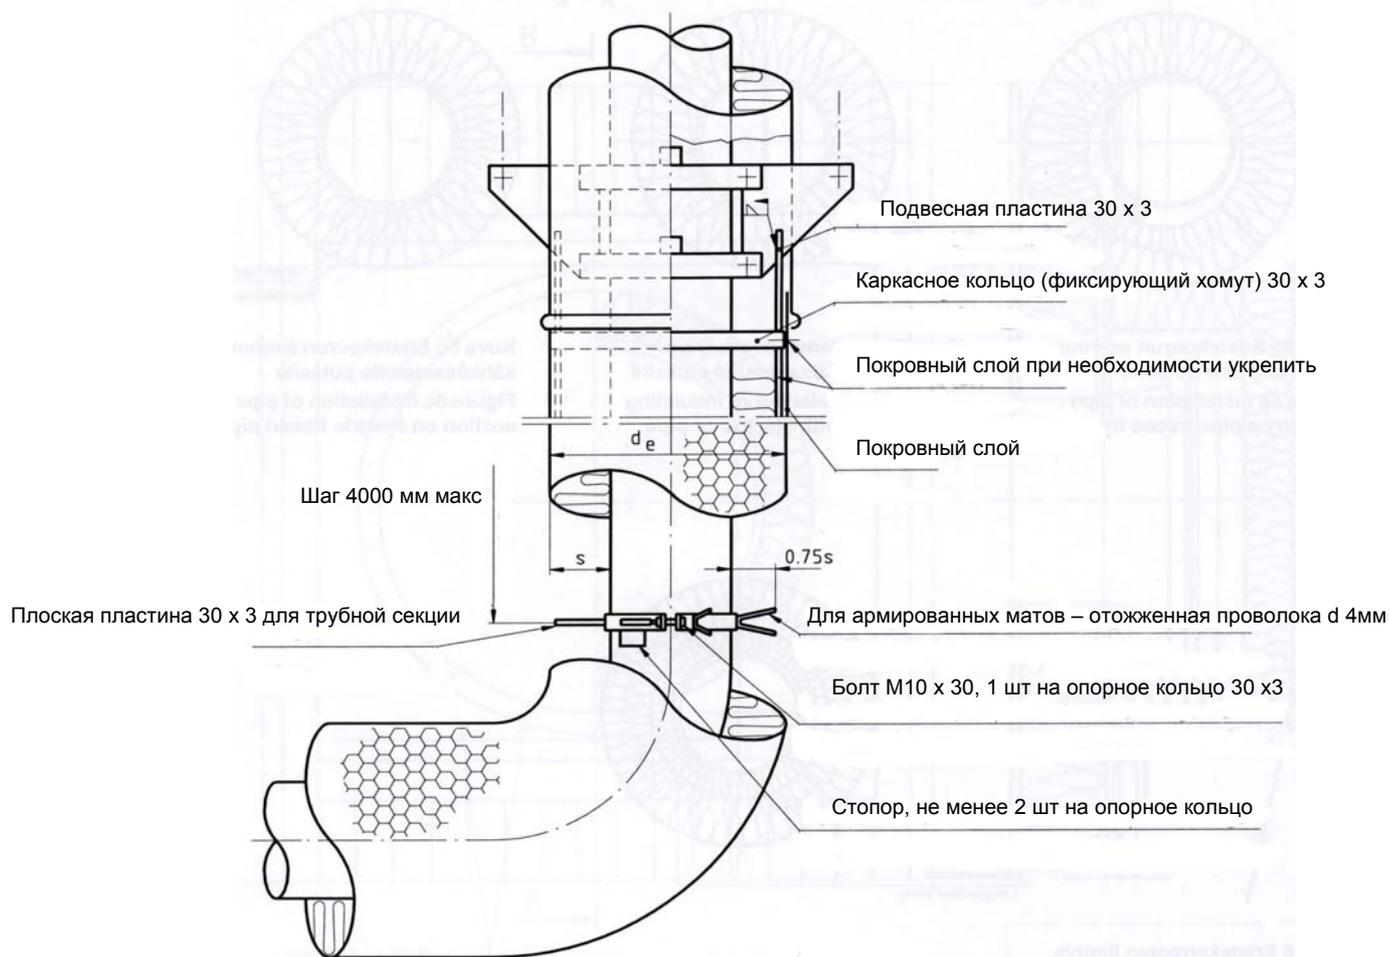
Монтаж армированного прошивного мата на трубопроводе
